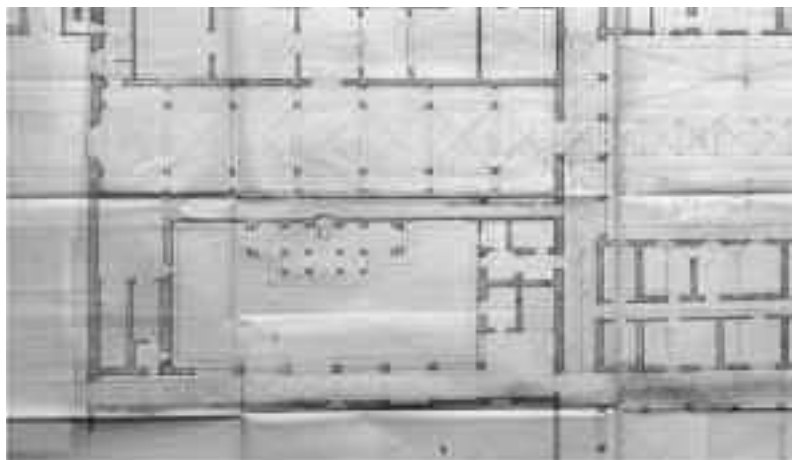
Pianta dell'Arcispedale*, 1891, particolare della planimetria del tempio Galli Tassi.
